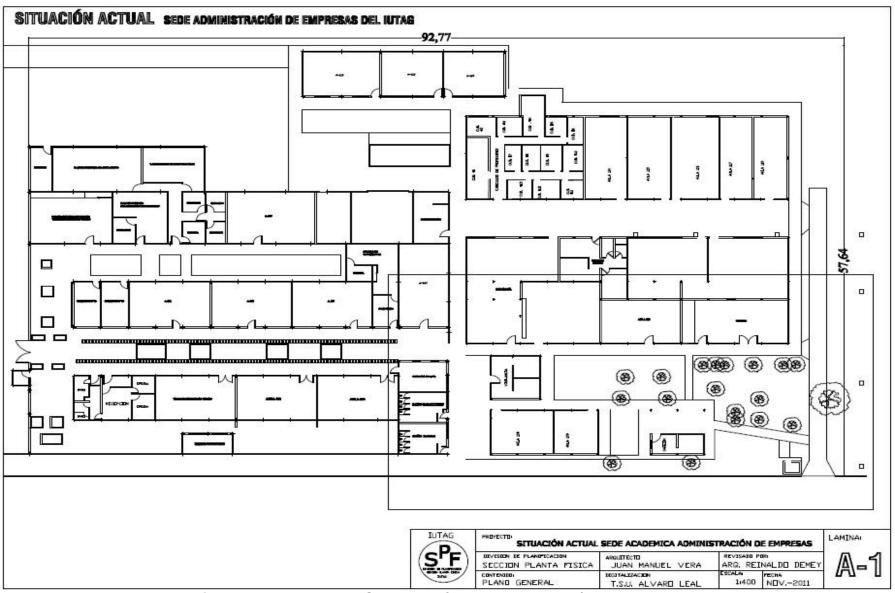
Plano de Sede Académica Administración de Empresas Fuente: División de Planificación, Sección Planta Física de la UPTFAG
